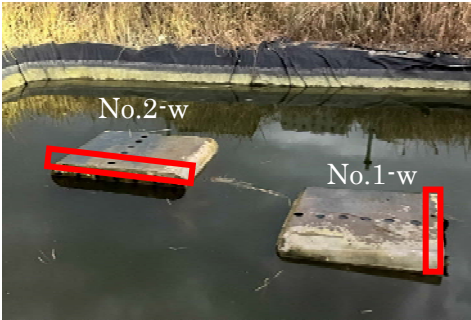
No.1-w, No.2-w の針貫入試験実施位置
